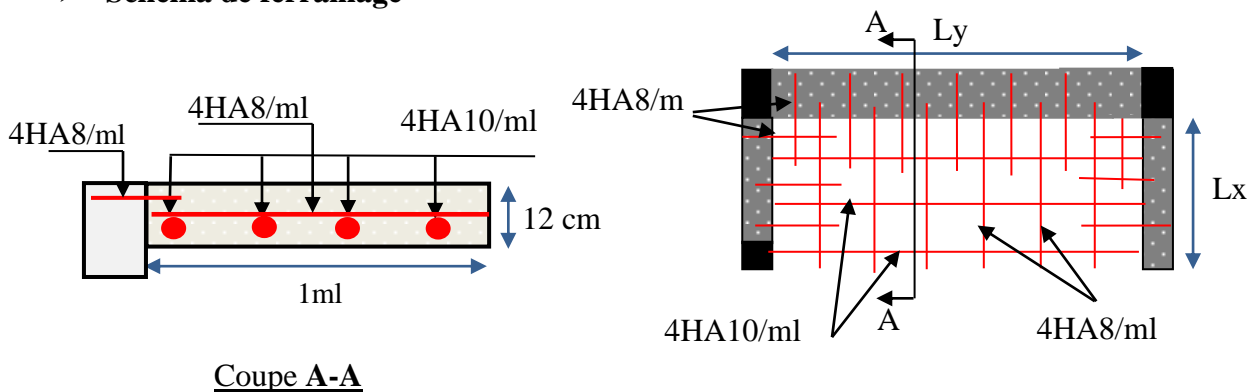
Schéma de ferrailage de la dalle sur 3 appuis
